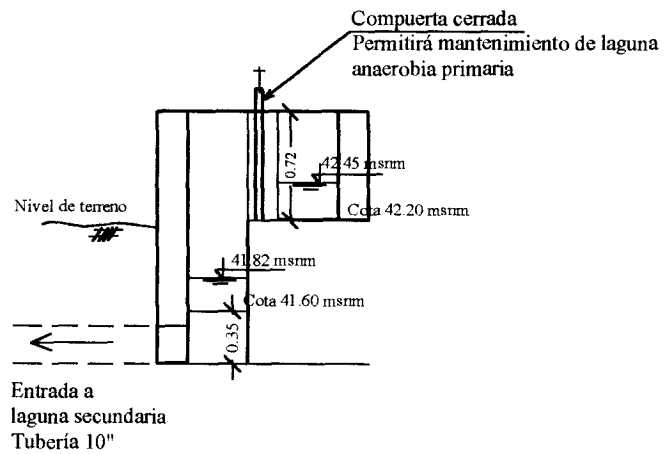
b. DETALLE B: Salida de laguna primaria (anaerobia proyectada).
